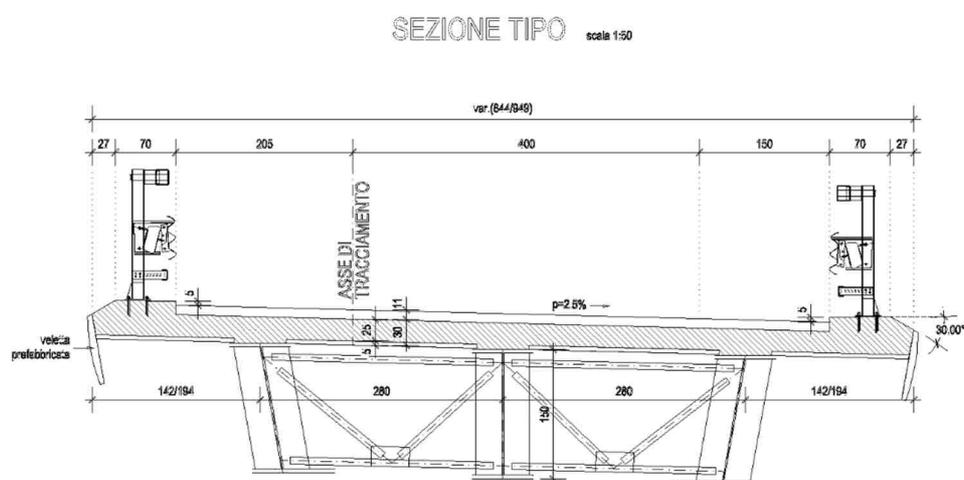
Sezione tipologica in campata – Cavalcavia Svincolo SS.125 – rampa 2
